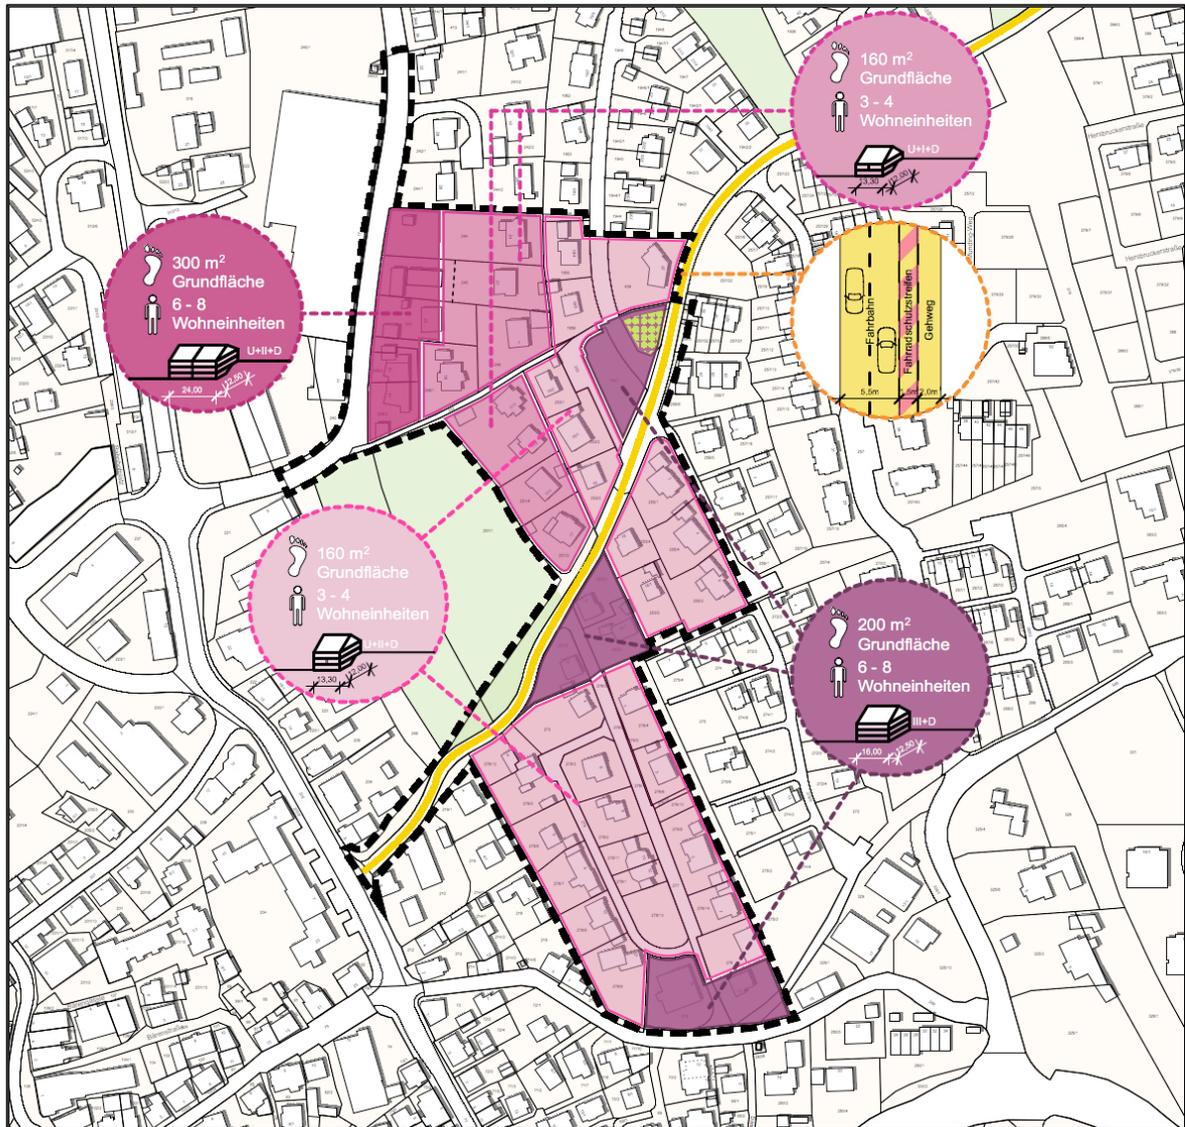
Rahmenplanalternative 2, Plan Nr. 14.2
